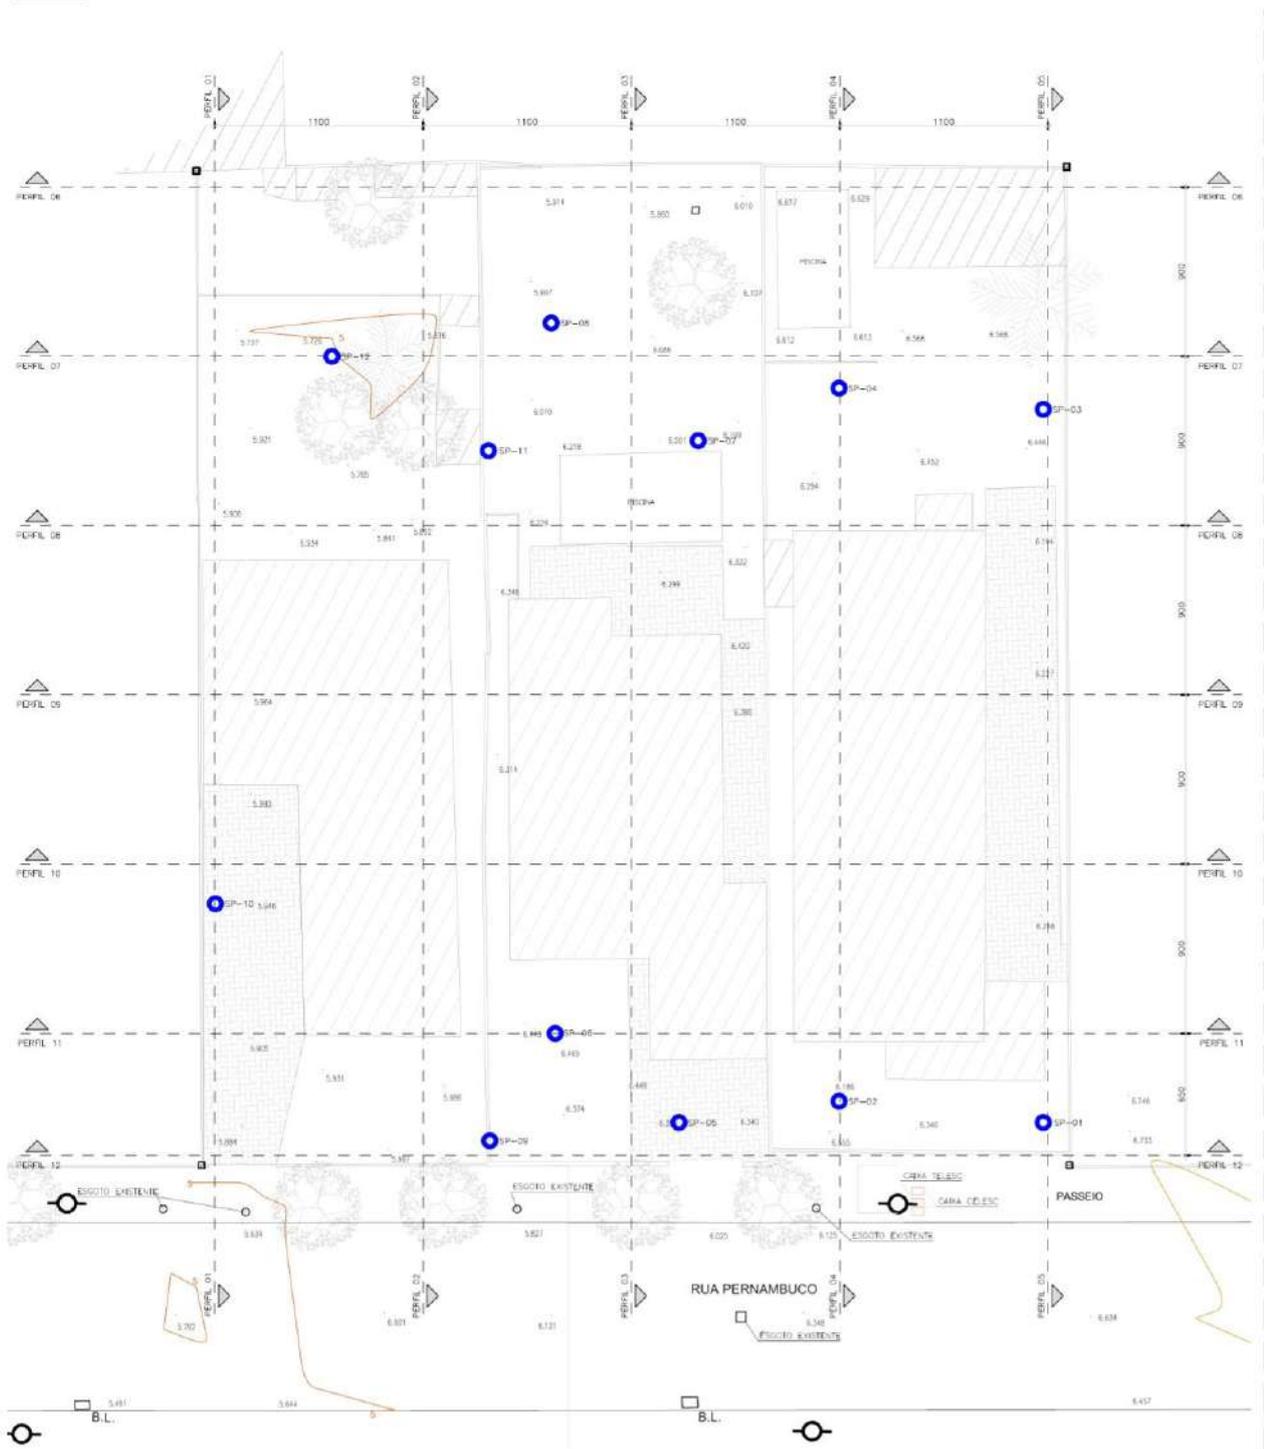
Planta baixa terreno natural com indicação pontos de sondagens. FONTE: Projeto de Terraplanagem 2P Engenharia.
